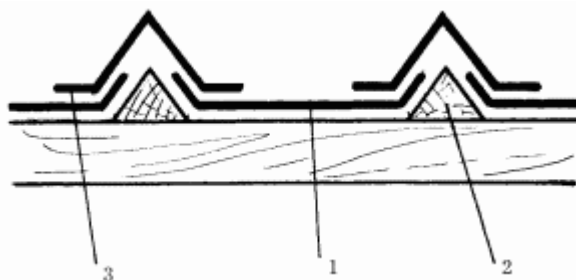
Устройство кровли с использованием треугольных брусков: 1 – рулонный материал; 2 – треугольный брусок; 3 – насадка из рубероида или толя.
